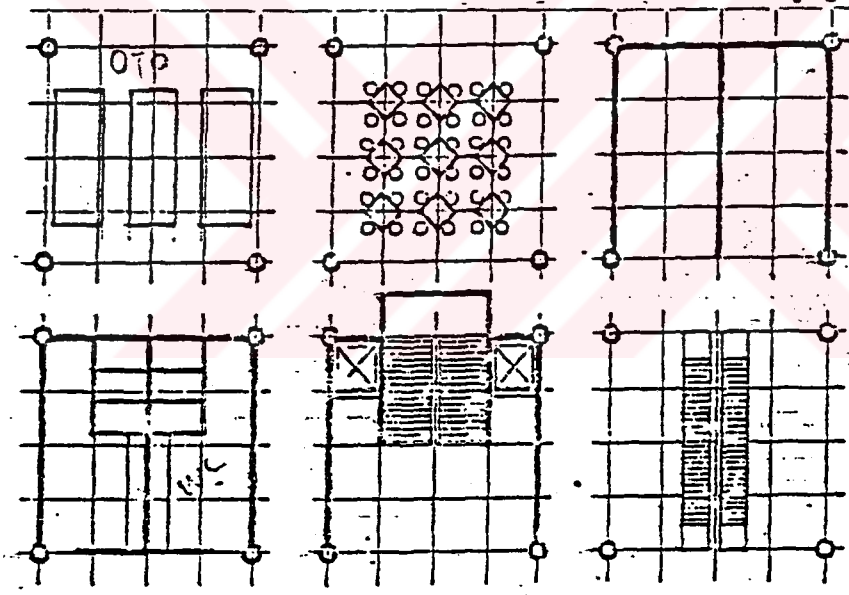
(6) HV ARAL-Büro Binası, BOCHUM, %10 Dönüştürülebilir Açık Planlı Büro
